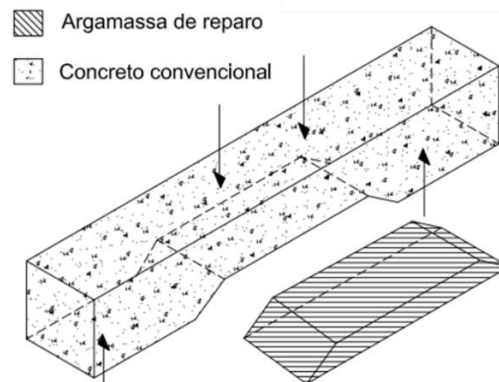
Sistema de reparo no banzo tracionado da viga.
